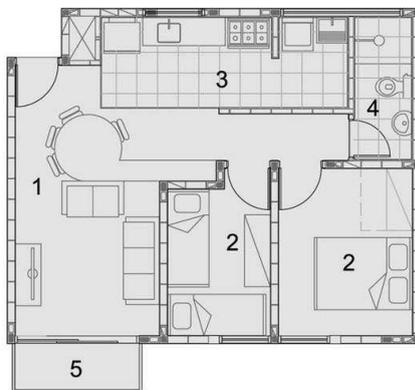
Planta térrea - Fonte: Archdaily, adaptado pelo autor
